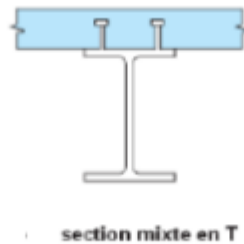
exemple d'une poutre mixte avec profilé ouvert
